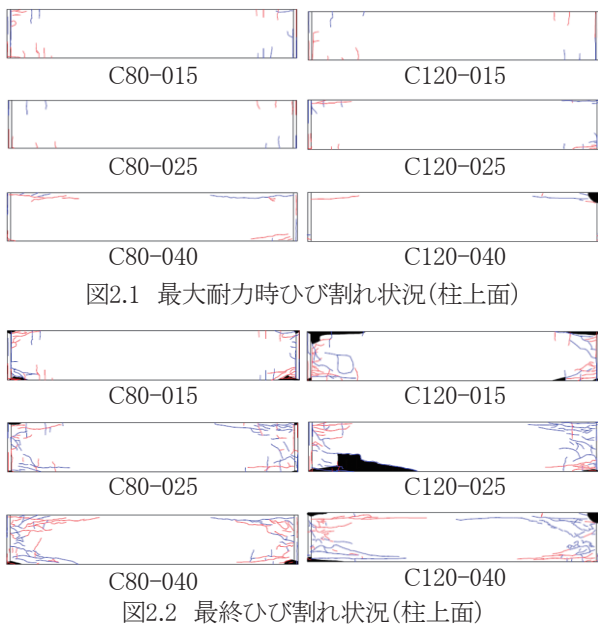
最大耐力時ひび割れ状況(柱上面)
